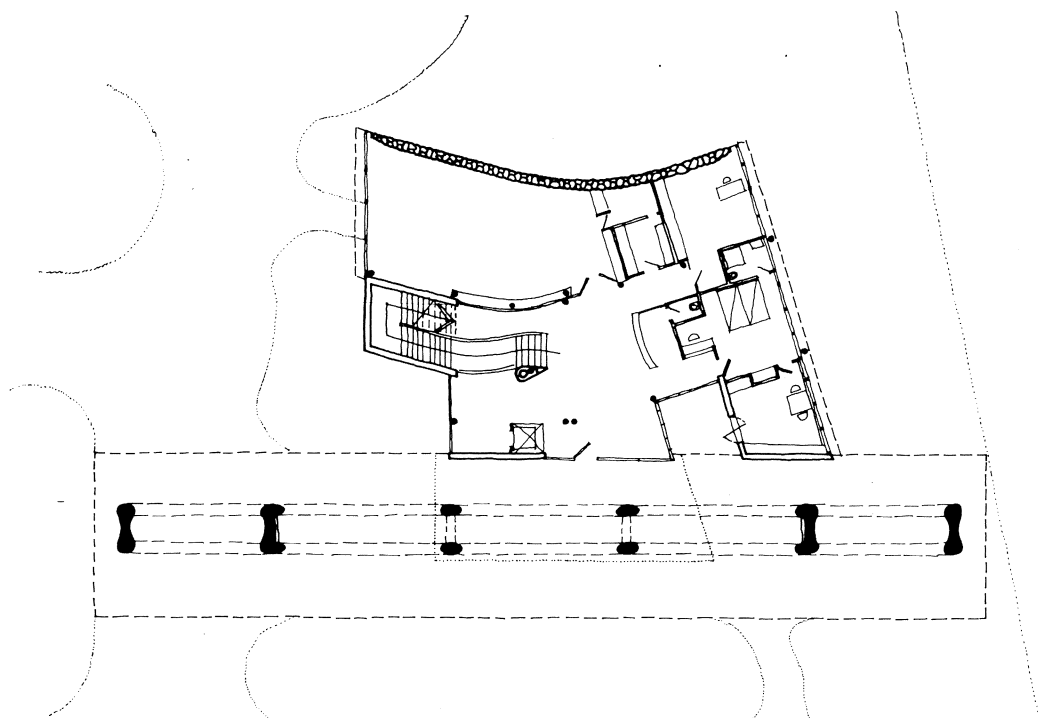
PABELLON SUIZO - PLANTA BAJA.
